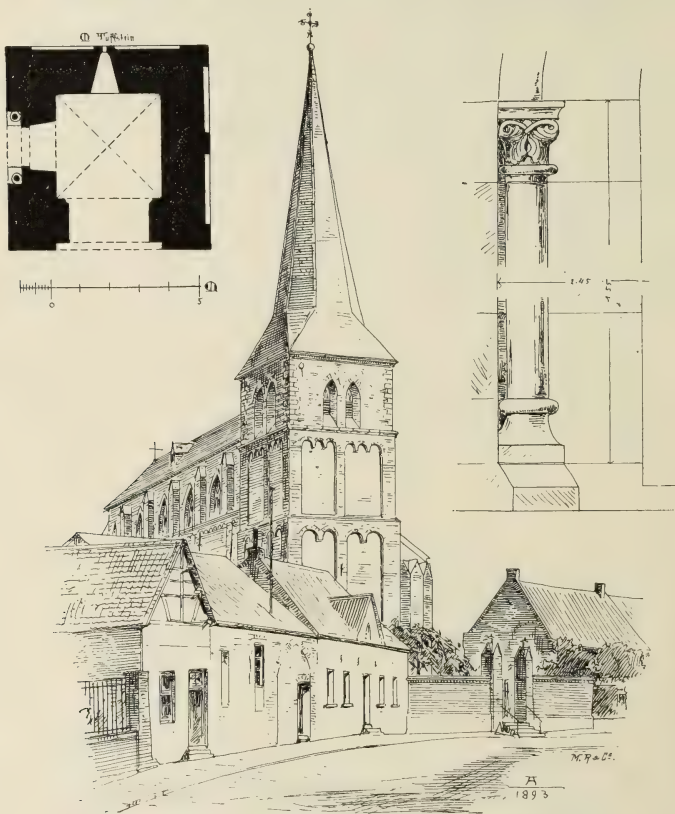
Elsdorf. Ansicht der katholischen Pfarrkirche mit Grundriss und Details des Turmes.
